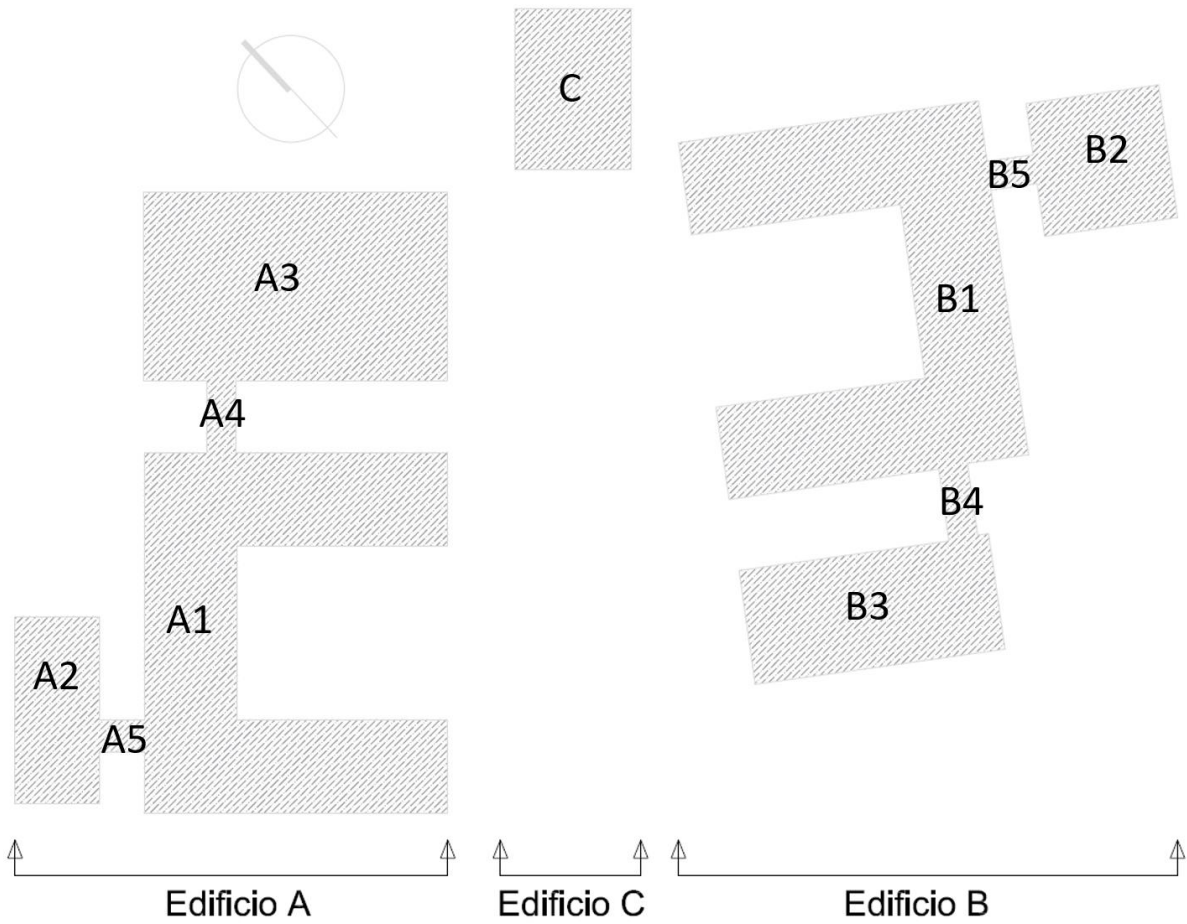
Planimetria con individuazione degli edifici del plesso scolastico
